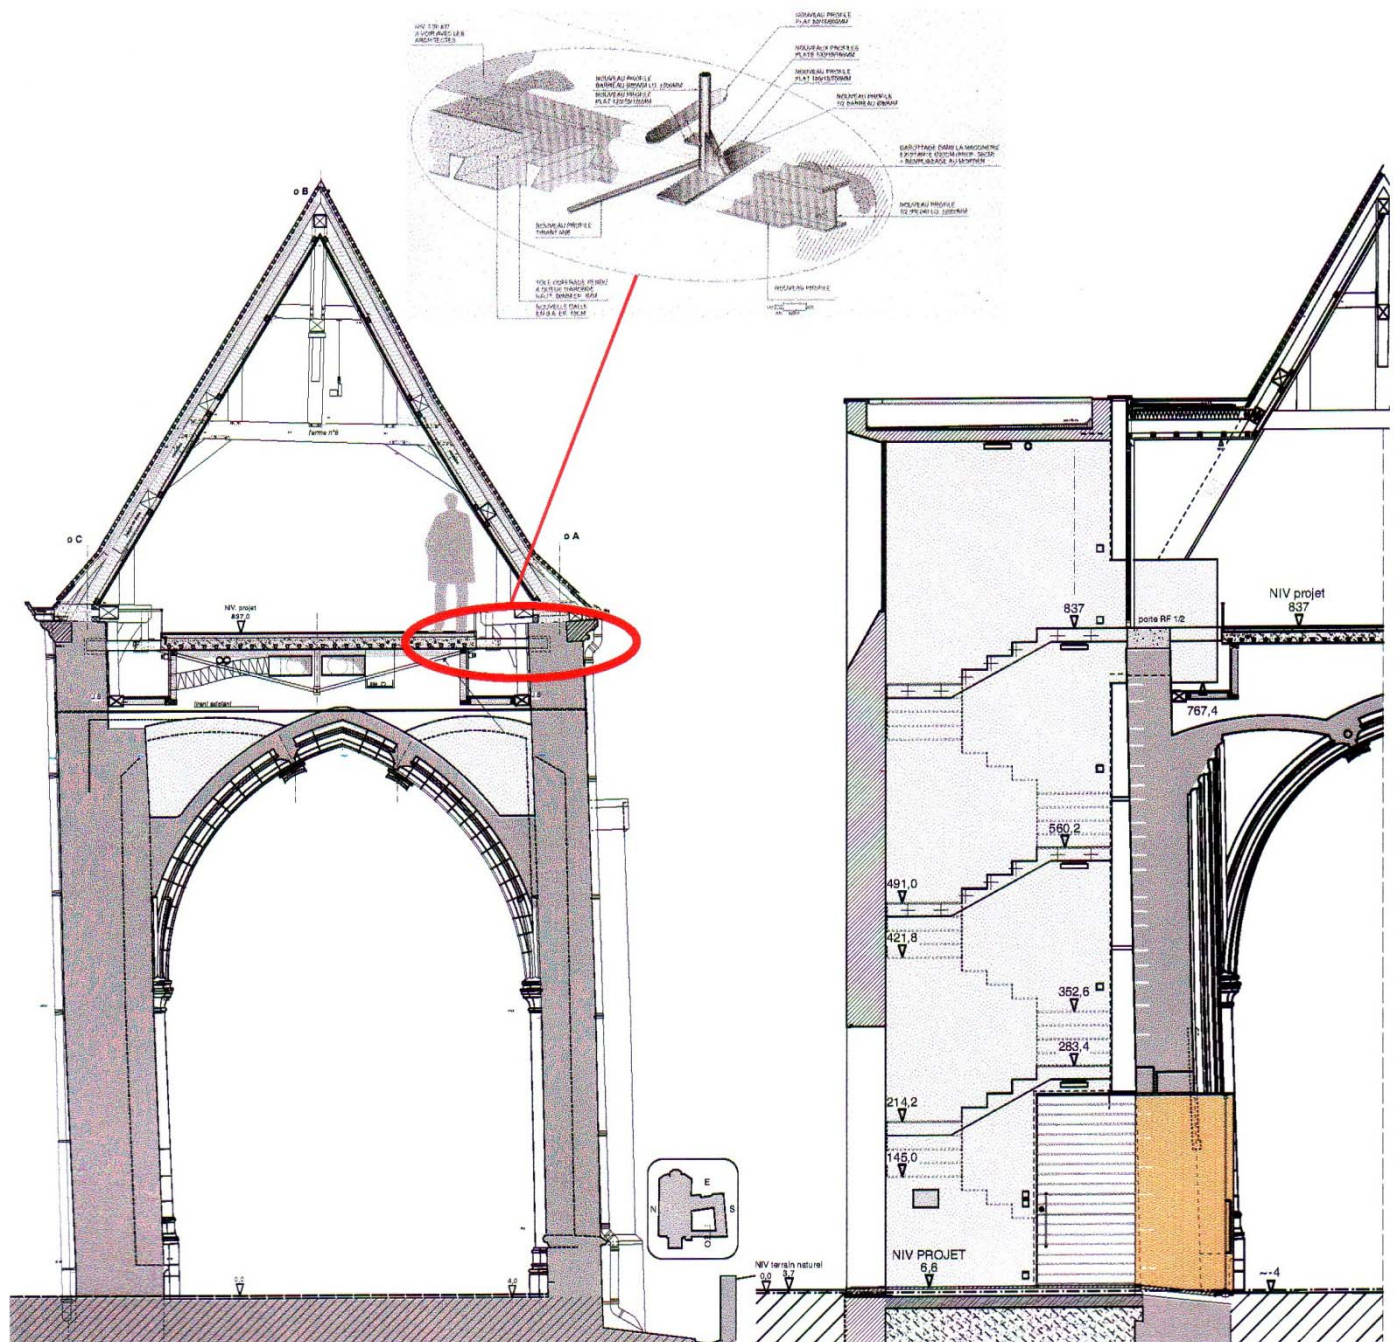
La stabilisation par la dalle en béton sous tendue et la tourelle d'escalier de secours comme contrefort de la muraille. (Janssen, 2009)
